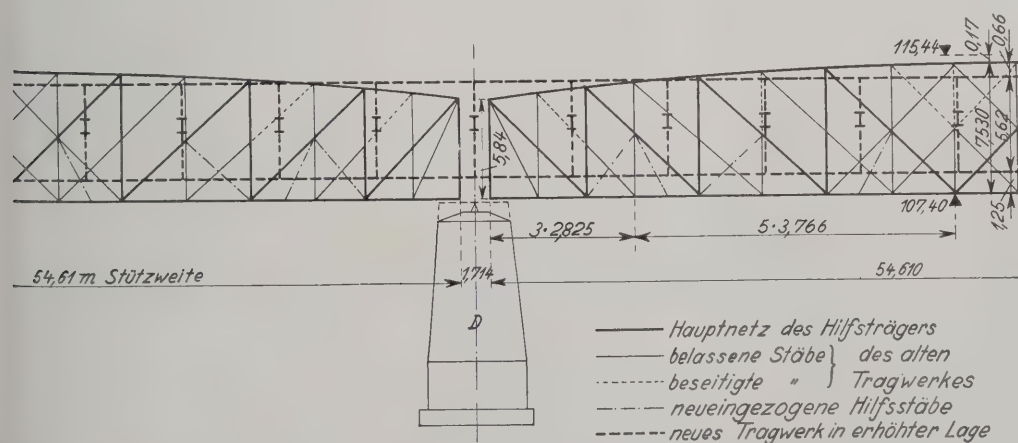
Abänderung des linken Hauptträgers für den Einbau der neuen Brücke.
